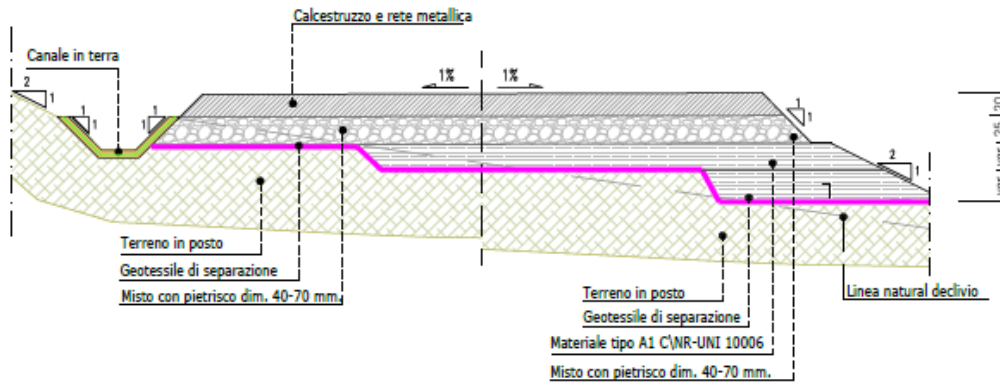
Sezione stradale tratti a mezza costa ($p > 13\%$)
